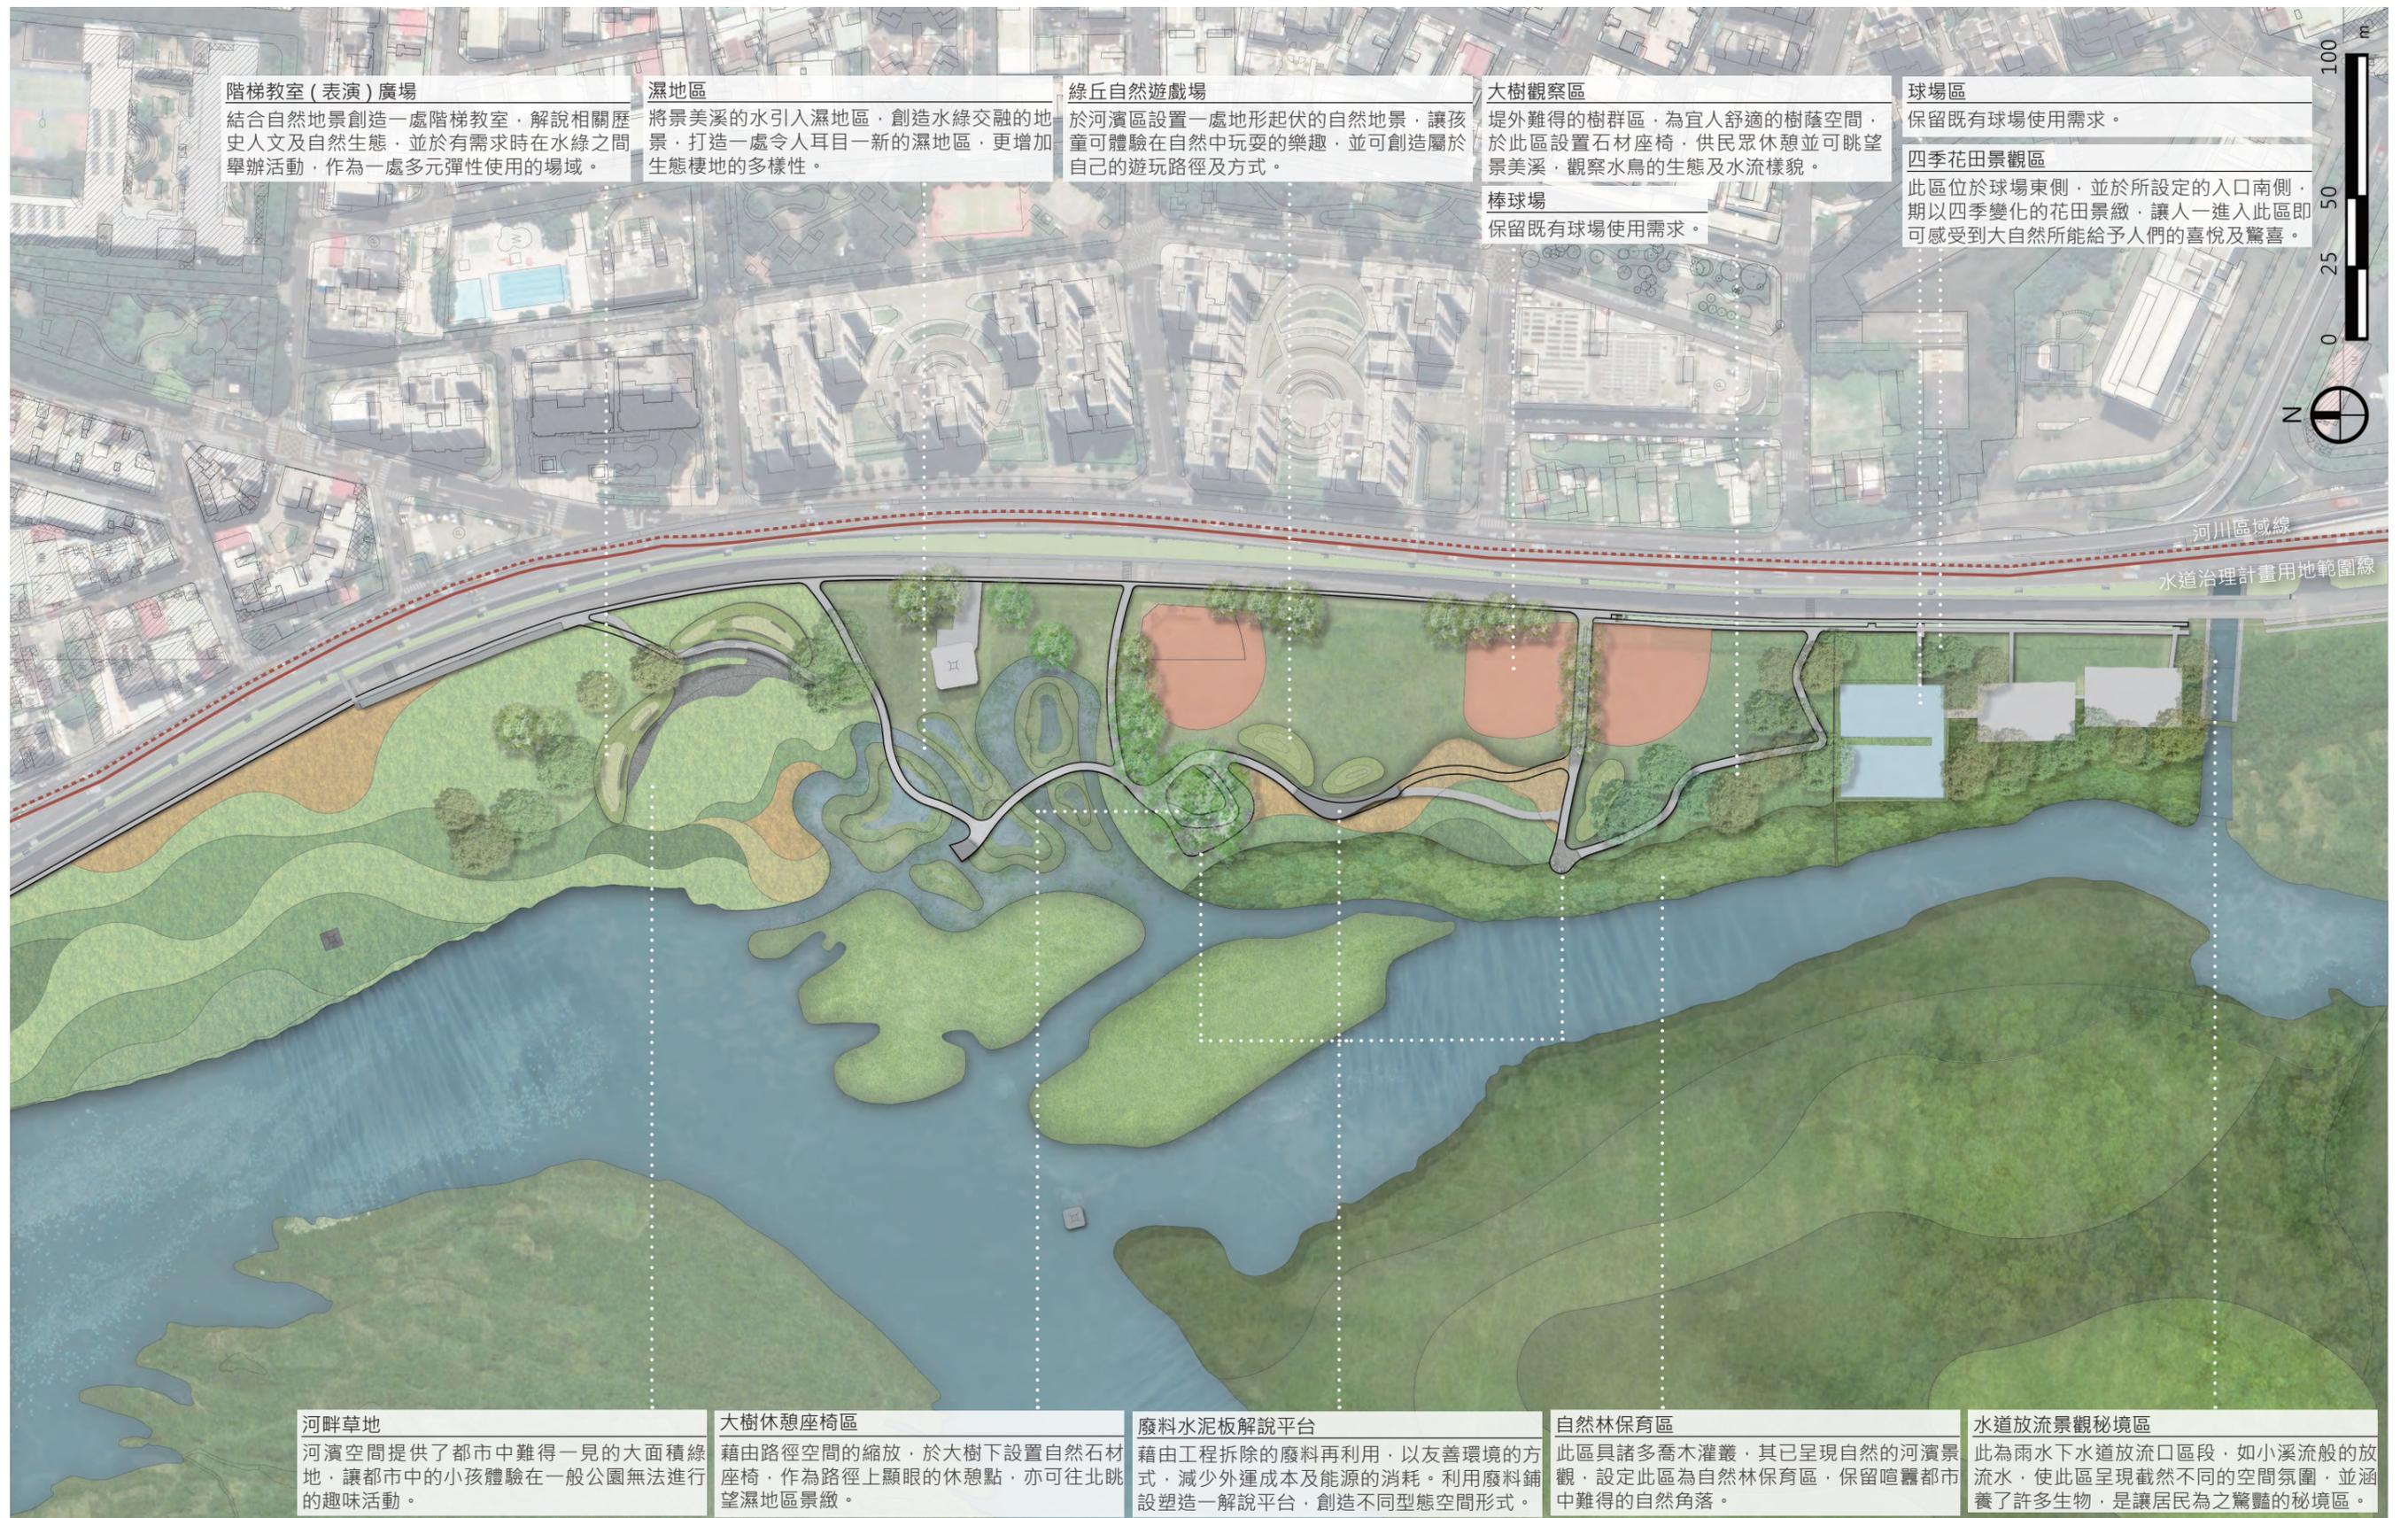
市民水文化見學段 - 平面配置設計圖
